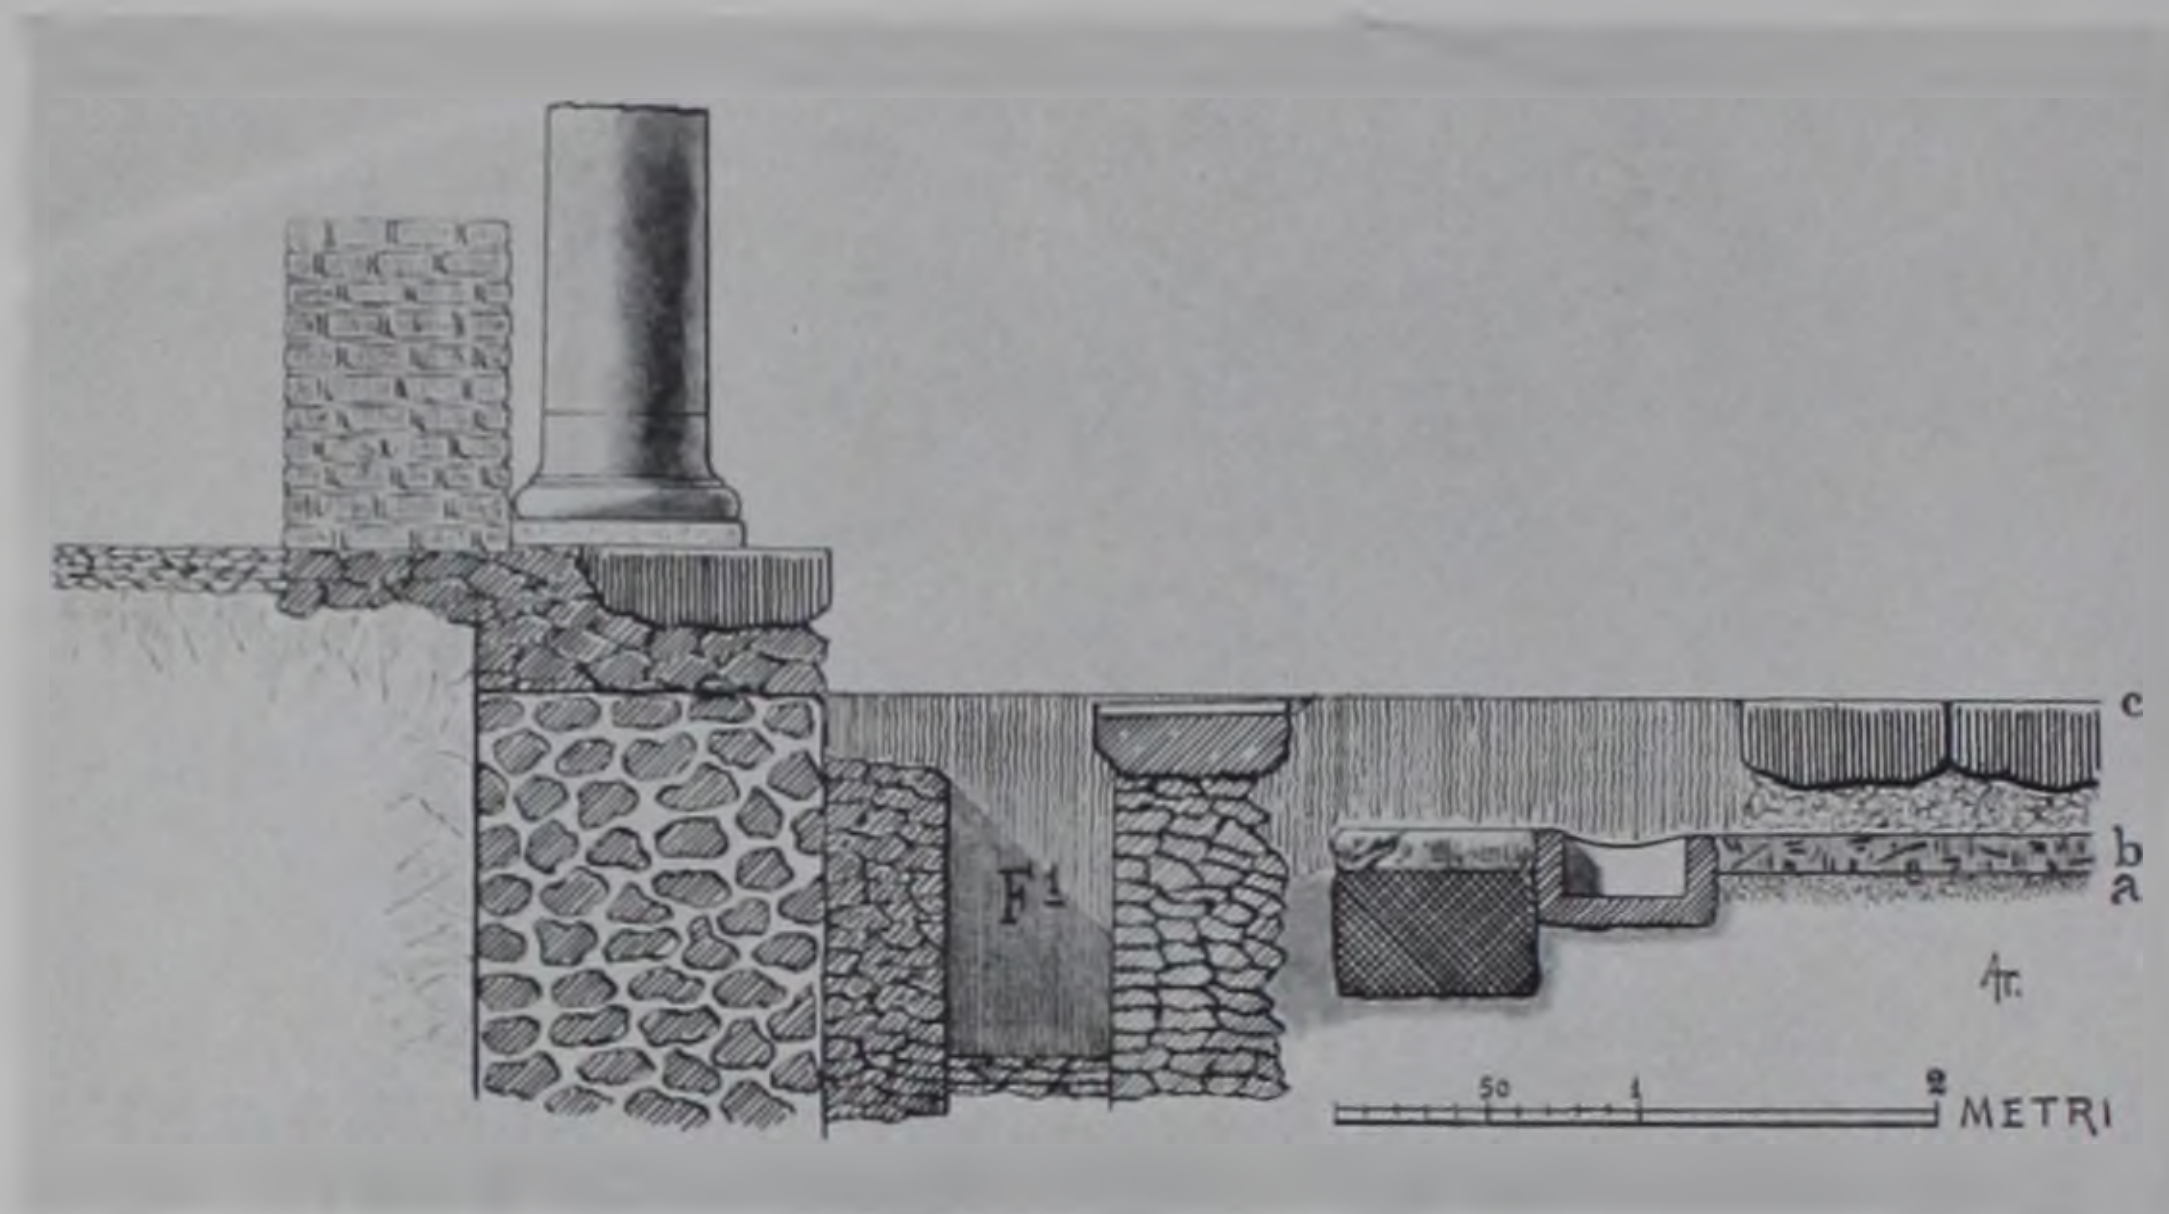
a-b. Strati della pavimentazione del Foro (sezione da est ovest e da ovest-est).
